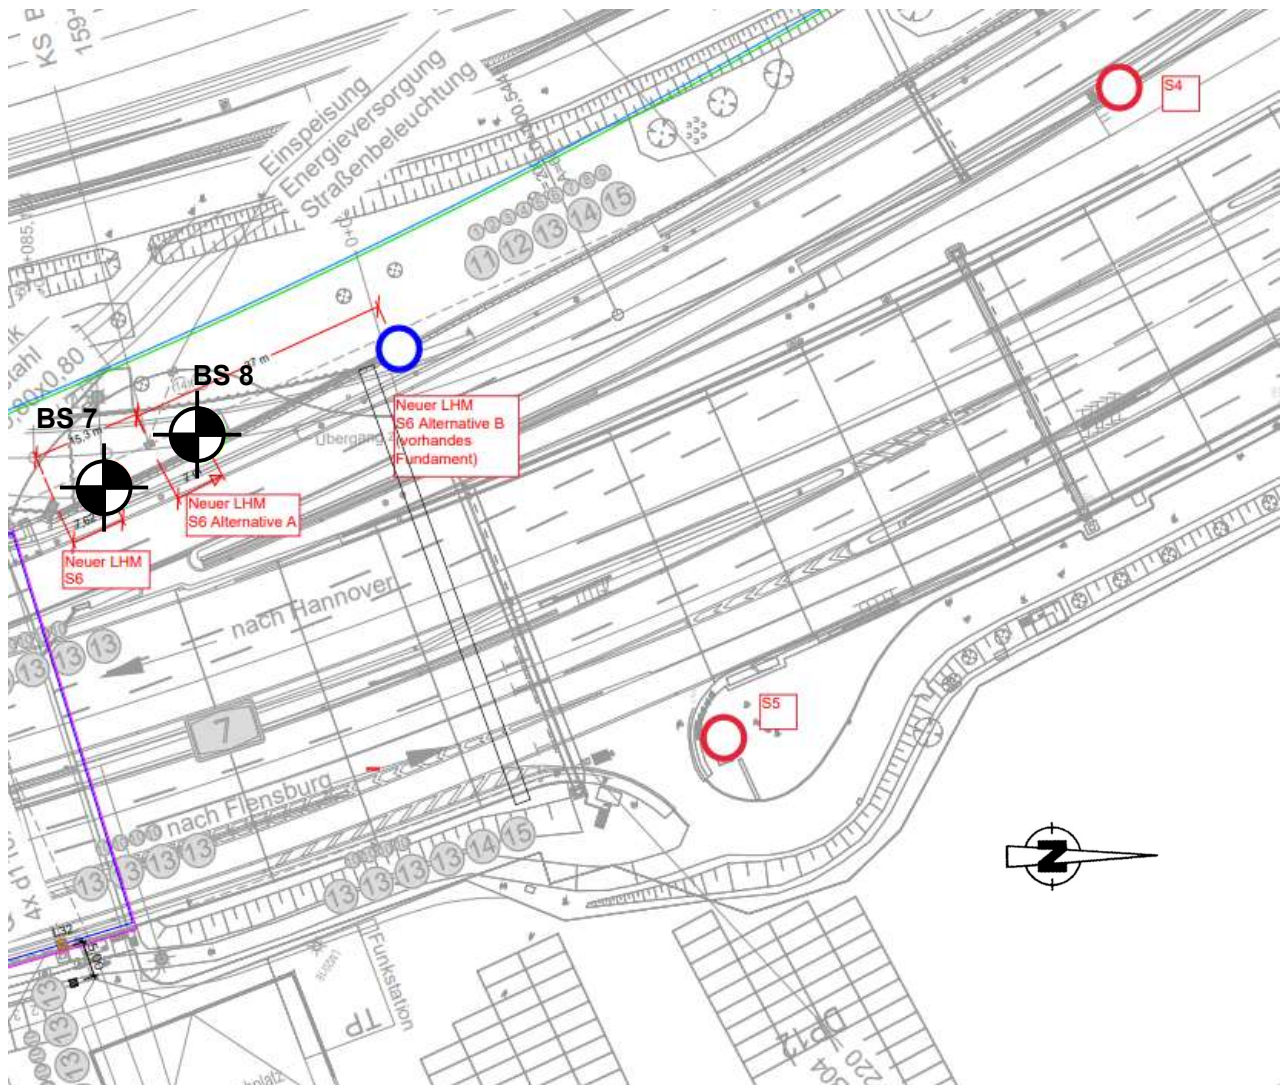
Lageplan Baugrundaufschluss Mast S6, M 1:1000
